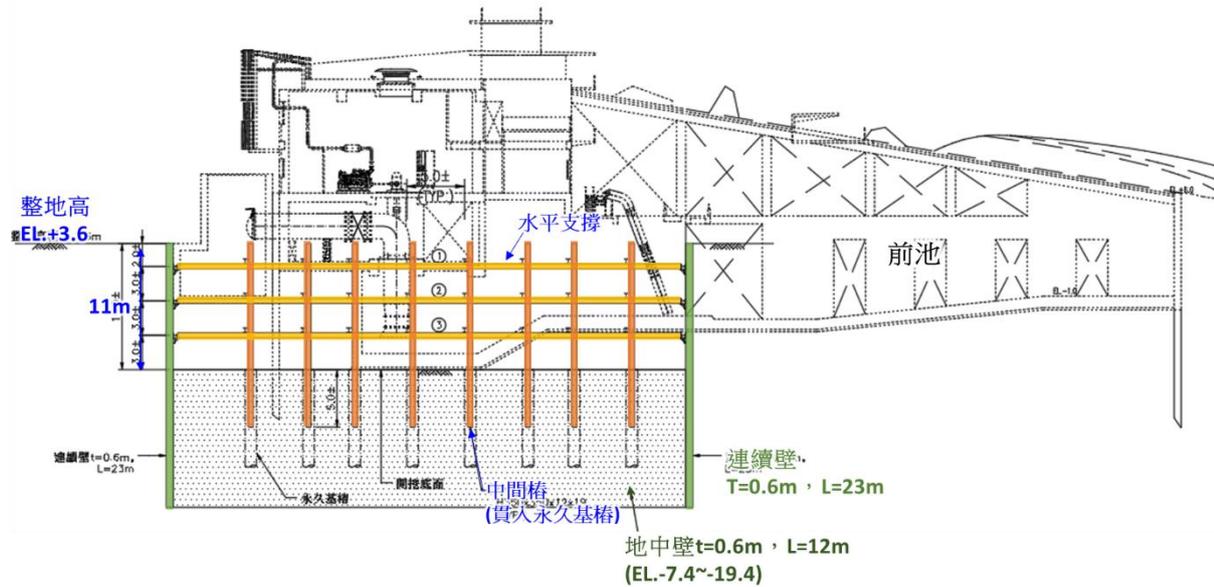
抽水站主體開挖擋土平面圖
